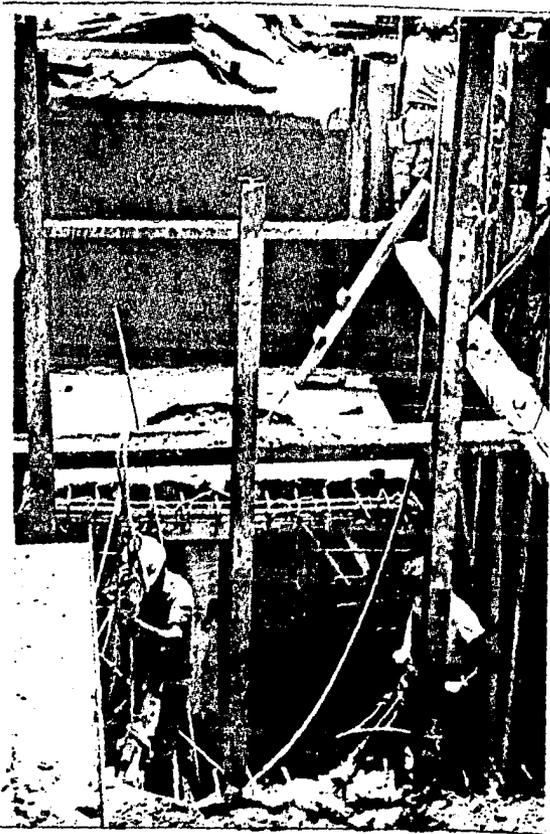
Construcción del pozo caja y demolición del muro de atraque.
